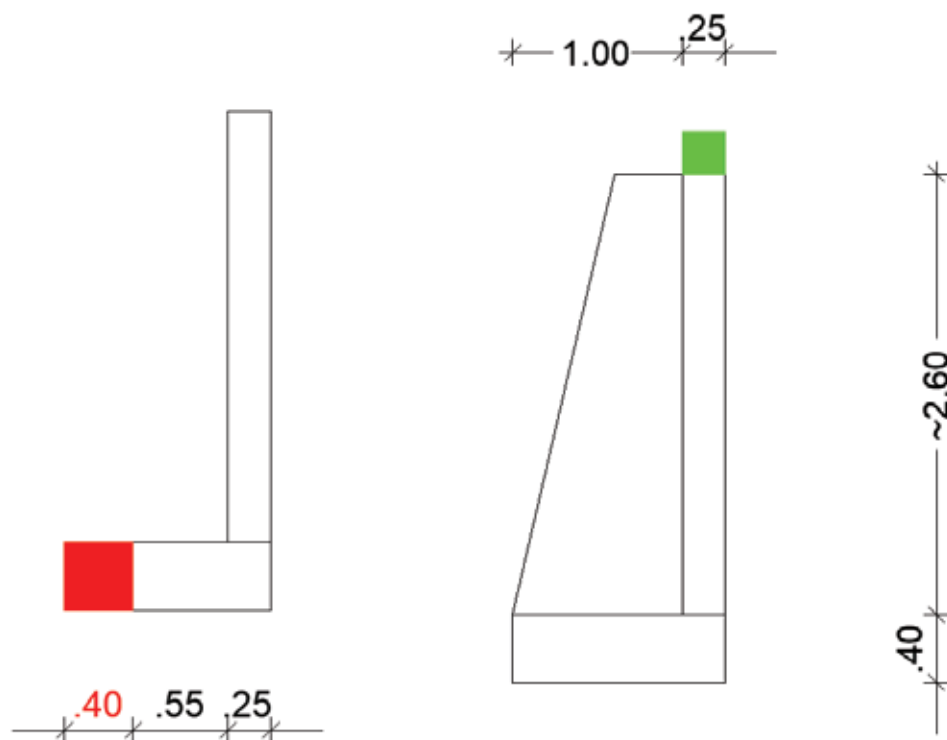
Sezione con allargamento del piano fondale e prospetto sperone da mantenere ed eventualmente sagomare
